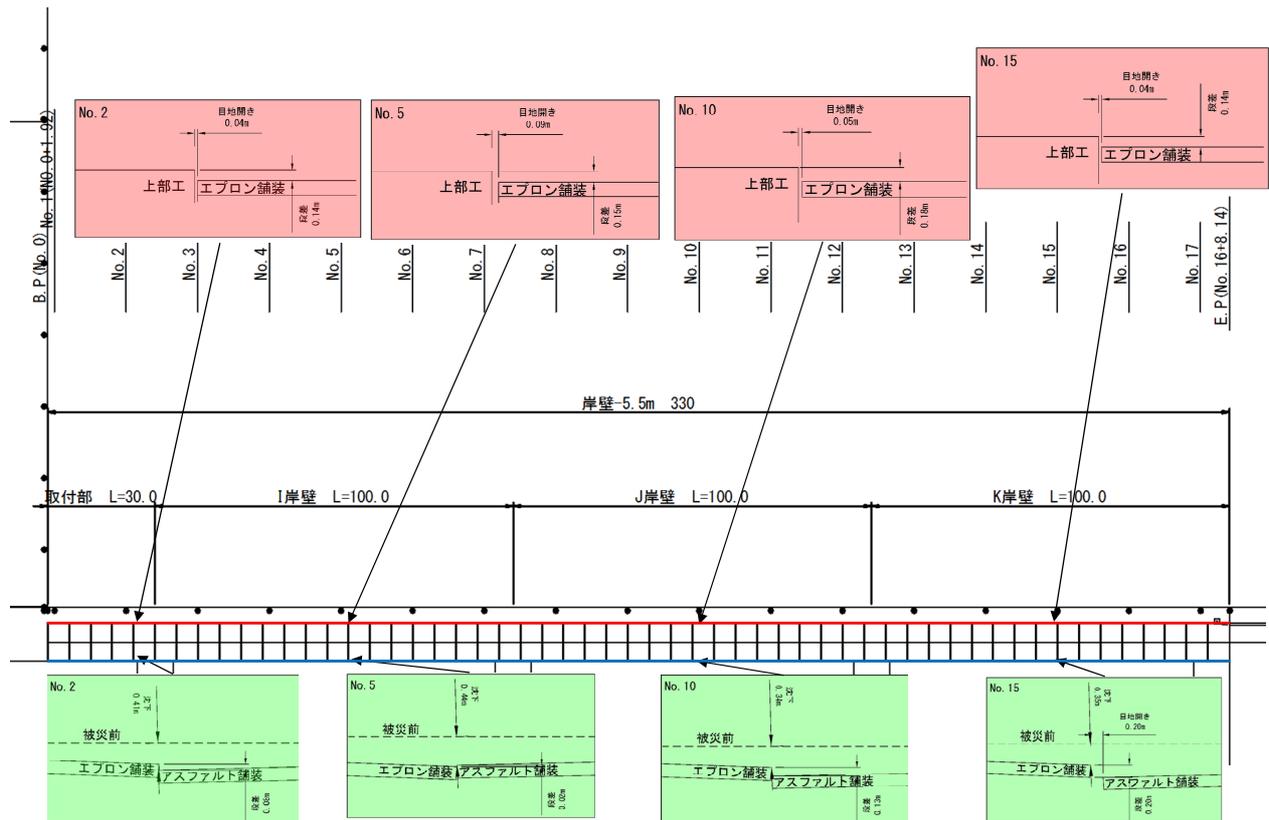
No.18 常陸那珂港区_北ふ頭地区岸壁 (-5.5m) I,J,Kの平面図 (被災後)
